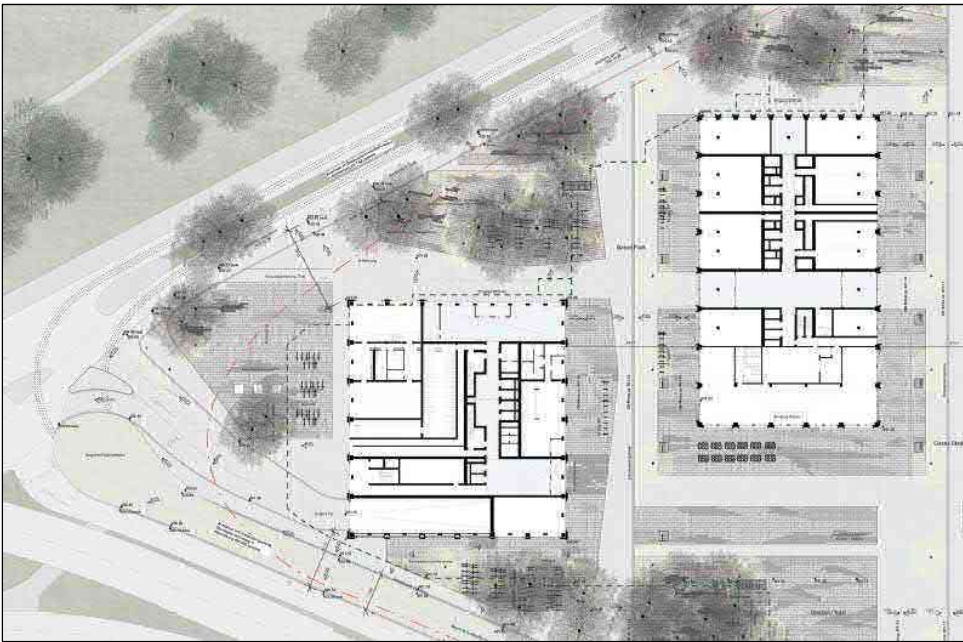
Hochhäuser West und Ost, Erdgeschoss und Erschliessung über Hardturmstrasse (Stand Richtprojekt, Quelle: Boltshauser Architekten, Caruso St John Architects, pool Architekten, Vulkan Landschaftsarchitekten)
